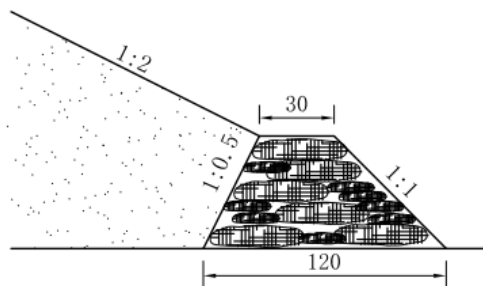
临时拦挡典型断面图 (单位: mm)
